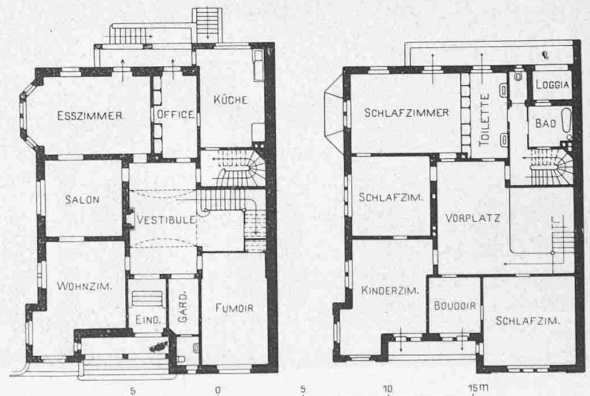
Grundrisse vom Erdgeschoss und Obergeschoss. — 1 : 400.
